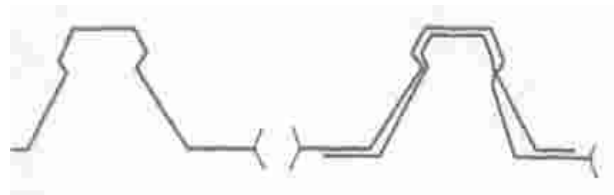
Blacha o przekroju trapezowym [15, s. 39]
